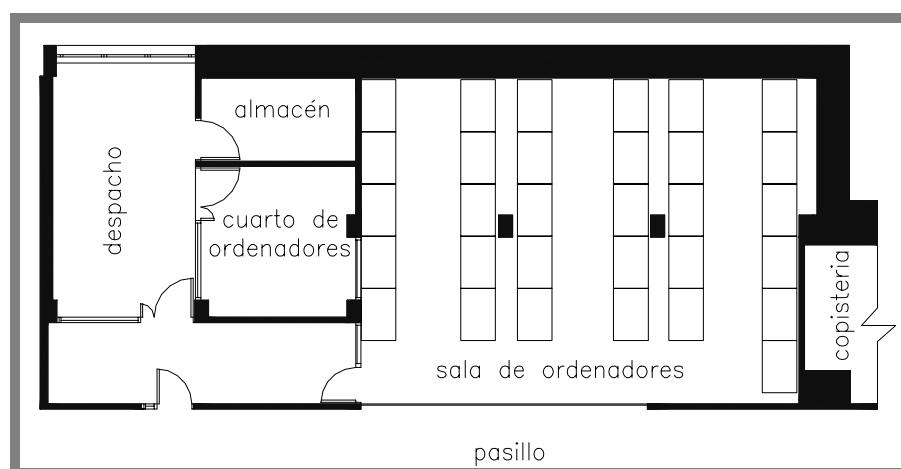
Planta Arquitectónica de la Sala de Ordenadores de la E.T.S.A.B.
